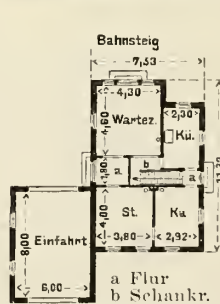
Stationsgebäude Fastrup-Windrup. Erdgesch.
